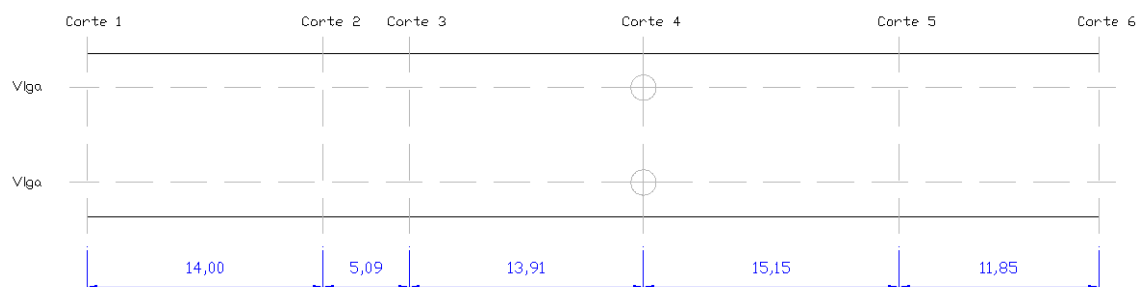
Planta de localização dos cortes na laje de betão para o dimensionamento.
